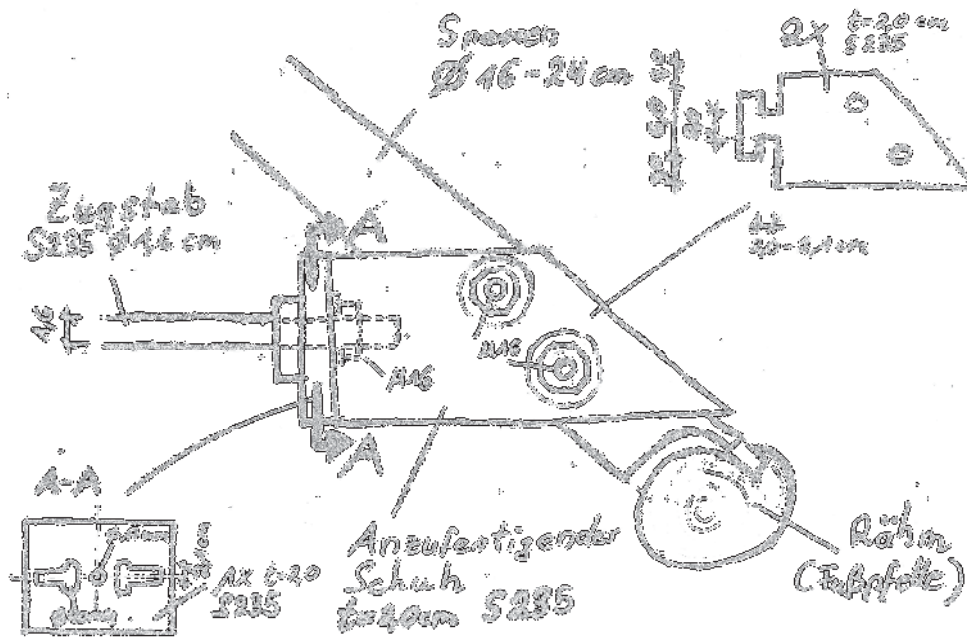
Detailanschluss: Zugstab an Sparren Variante 1
